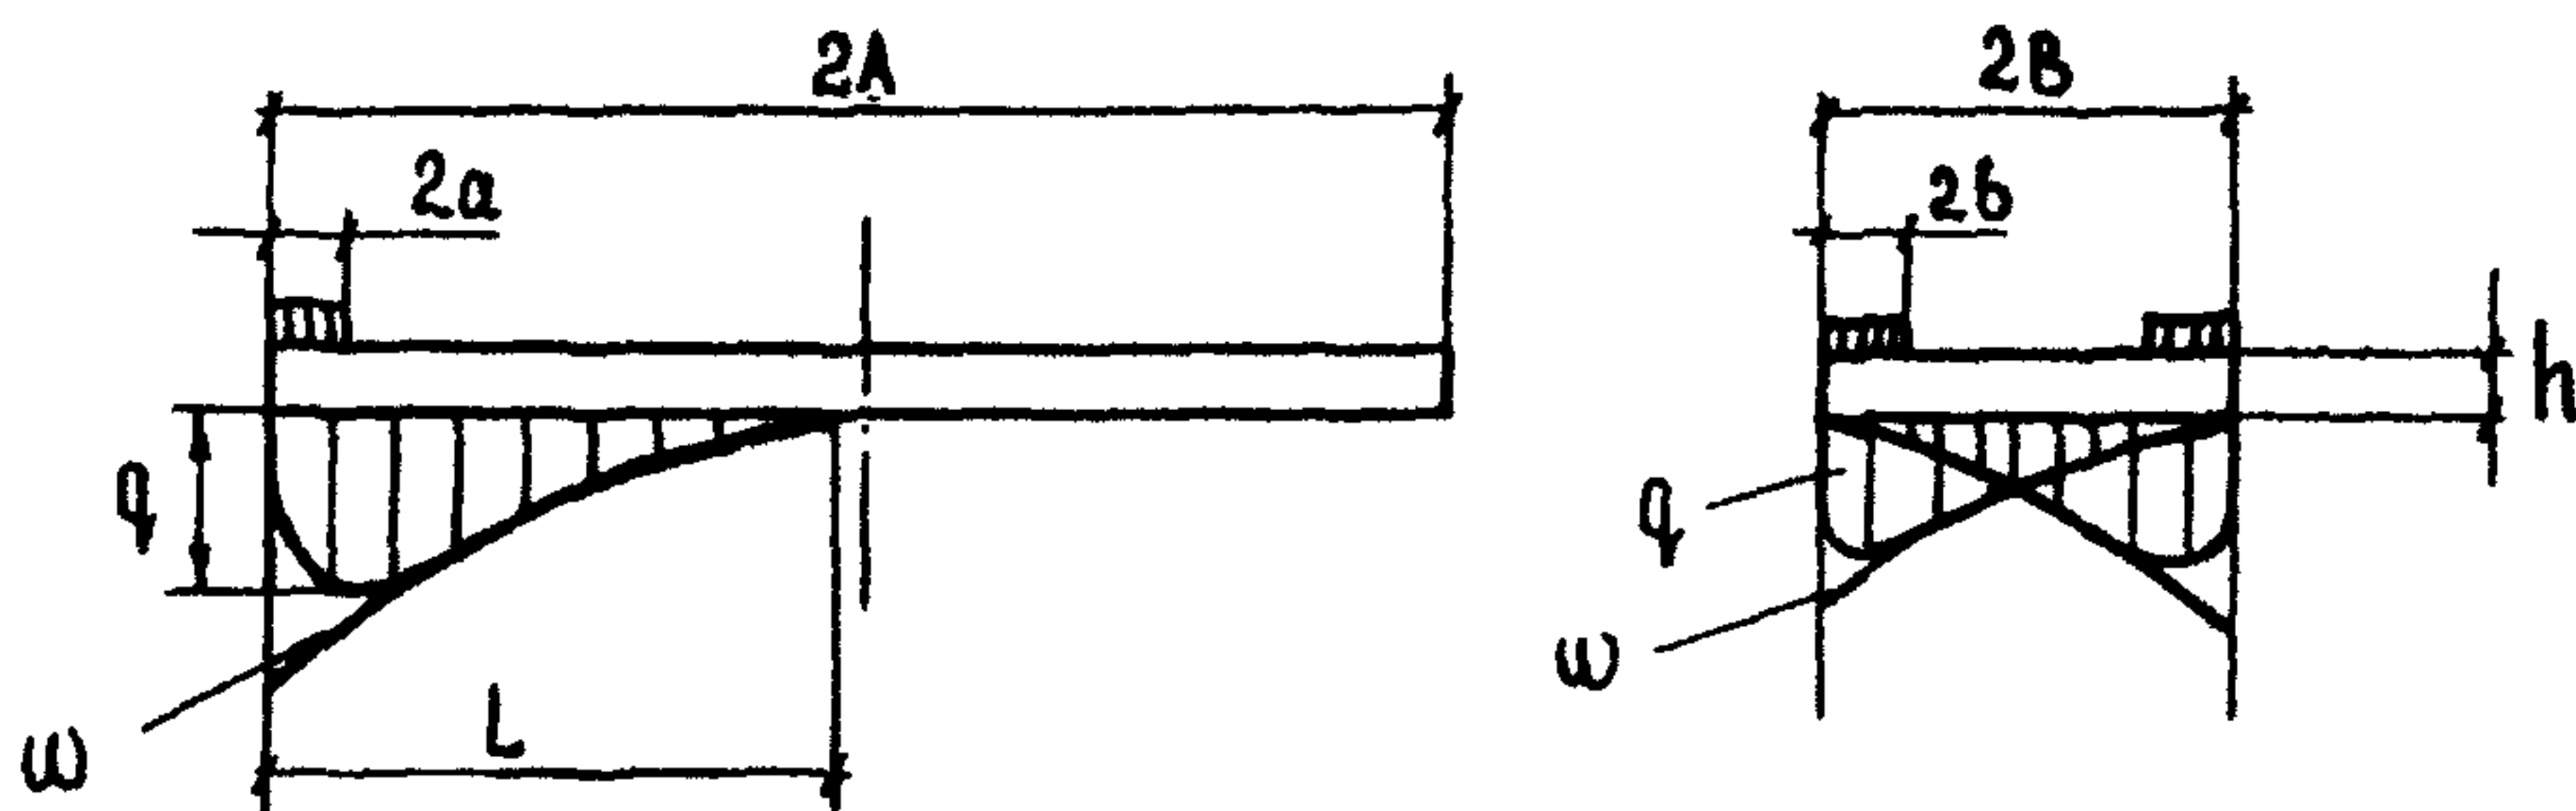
Схема расчета основания под сборными покрытиями из плит типа ПАГ-14
